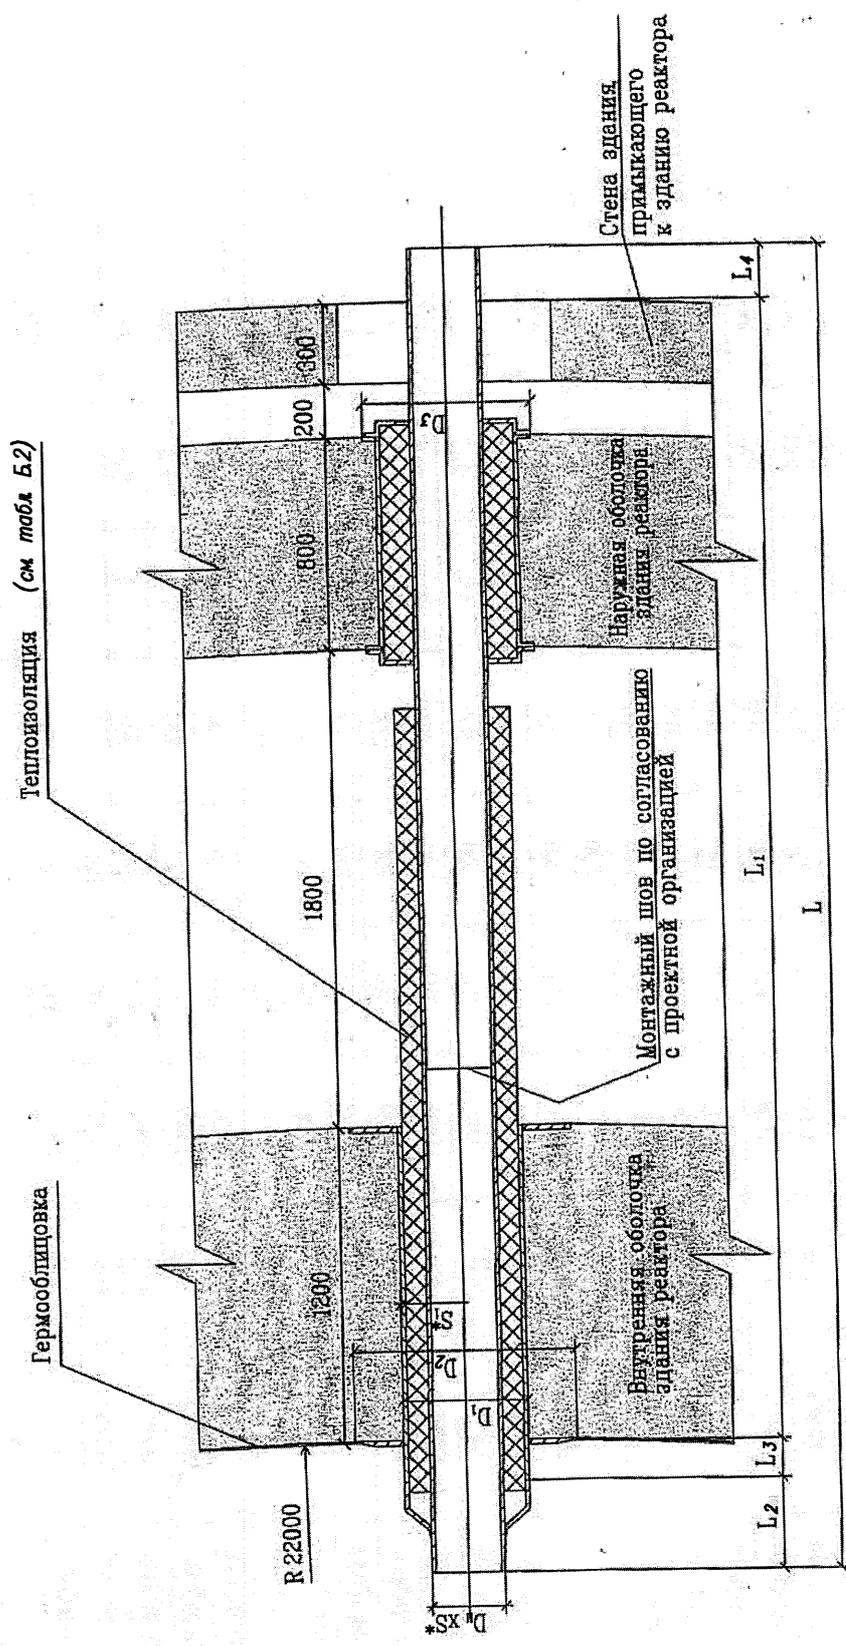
Габаритный чертёж герметичной проходки
